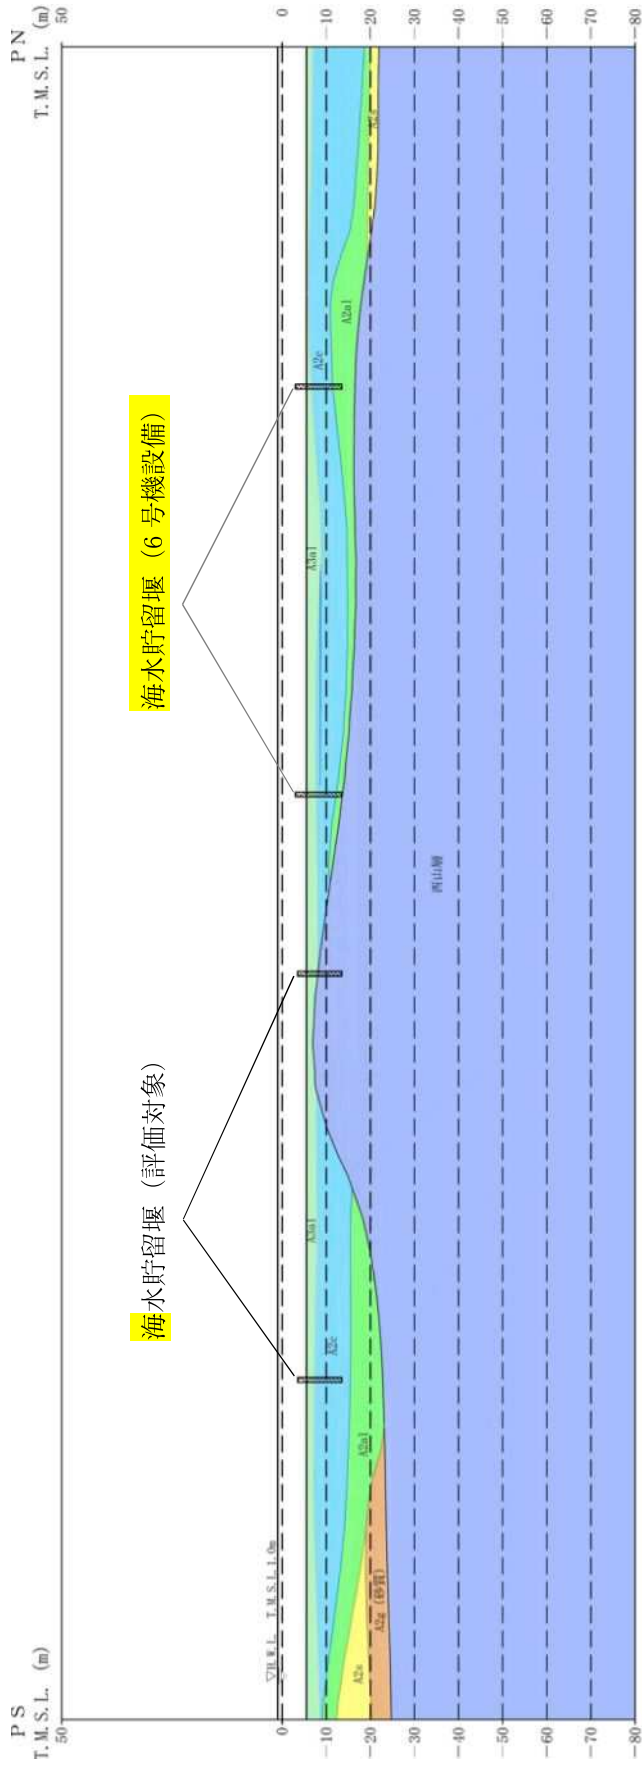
(1) 海水貯留堰の評価対象断面図 (A-A断面)
